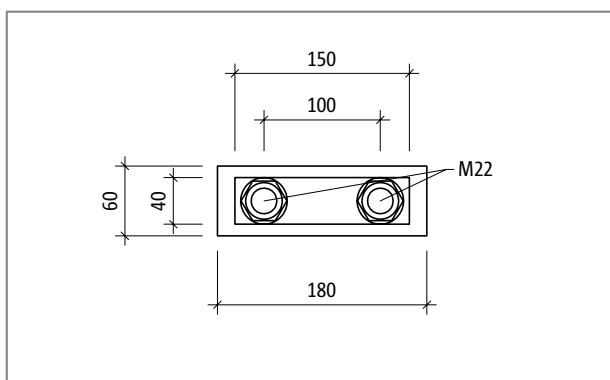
Schöck Isokorb® T tipo S-N-D22: vista dell'elemento
